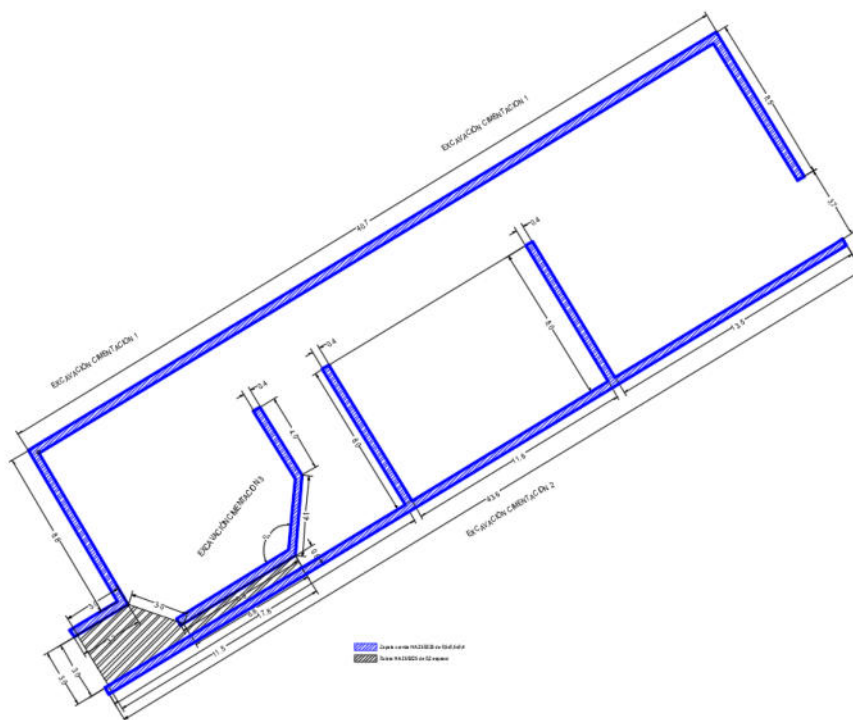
Planta manga, Rayado de azul excavación de zanja corrida de 40x50 cm a hormigonera una vez los postes se hayan presentado.
